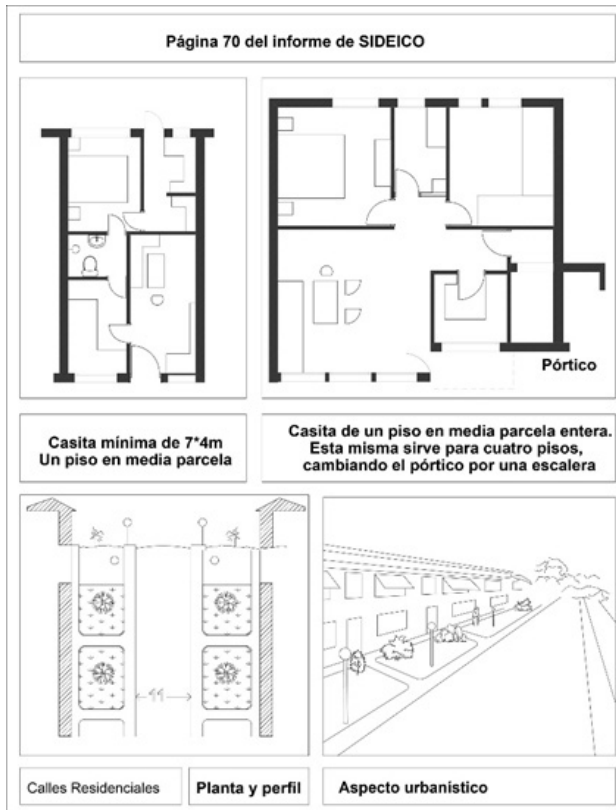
Planimetría del Plan Urbanístico Ibagué Futuro 1935
